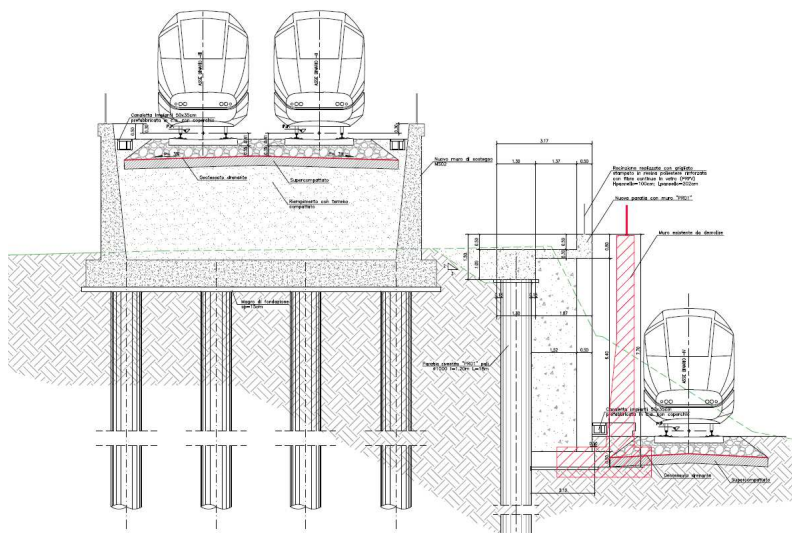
Sezione in corrispondenza della PR01 – tratto con muro e recinzione
